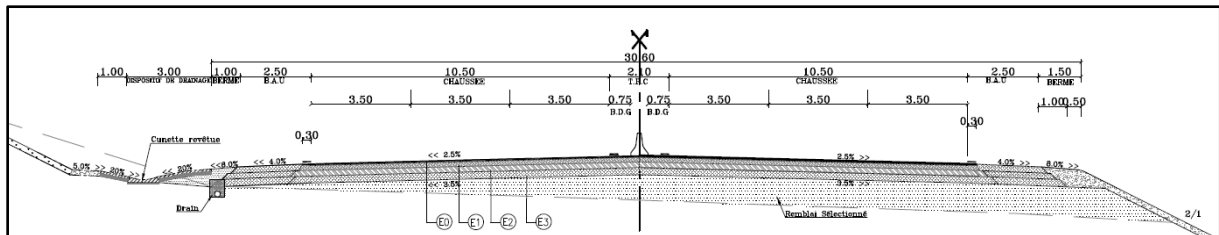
Profil en travers type proposé en relief difficile – Section courante
